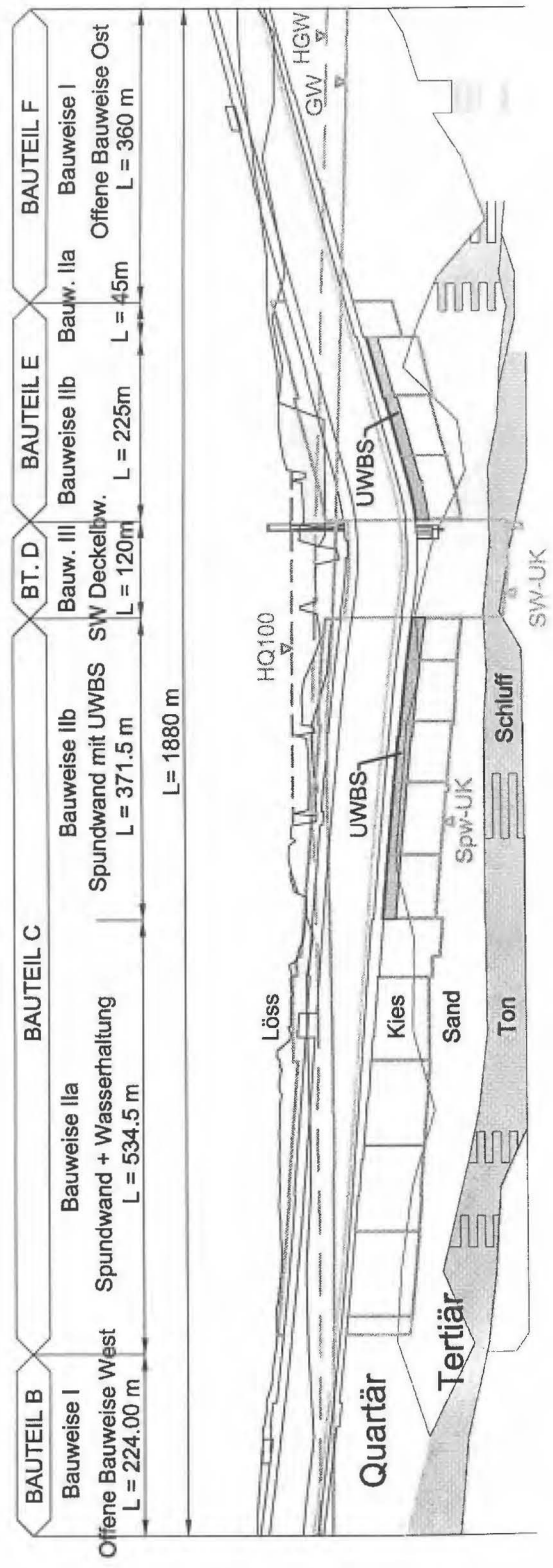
Tunnel Rannersdorf – Lageplan und Geotechnischer Längenschnitt
